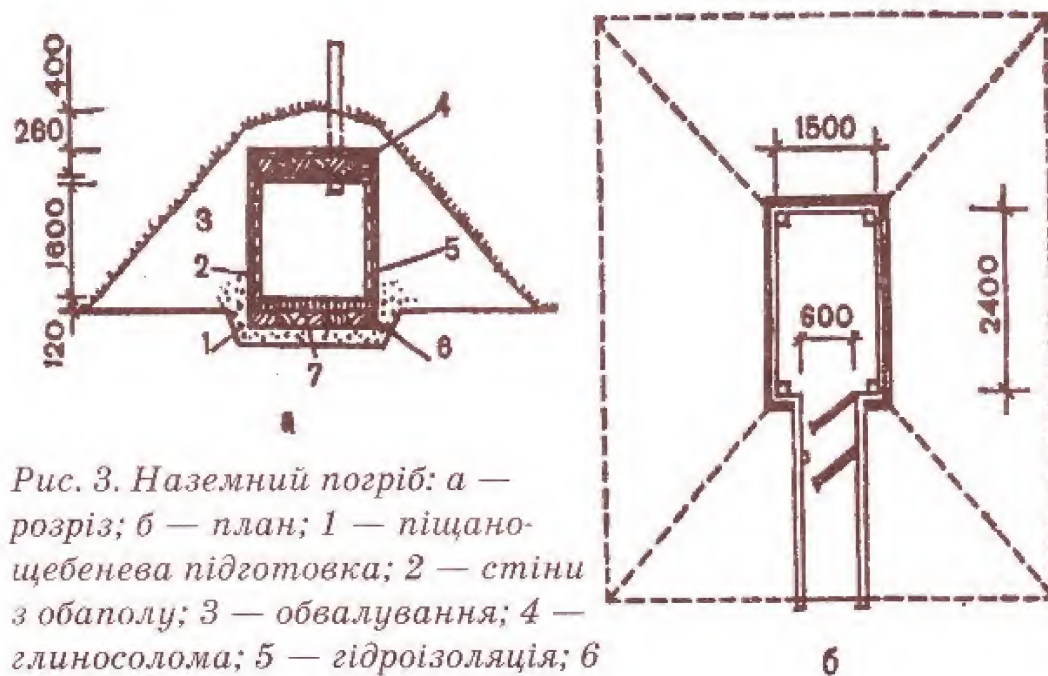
Наземний погріб: а — розріз; б — план; 1 — піщано-щебенева підготовка; 2 — стіни з обох боків; 3 — обвалування; 4 — глиносолома; 5 — гідроізоляція; 6 — глиняний замок; 7 — підлога (цегла "на ребро")
